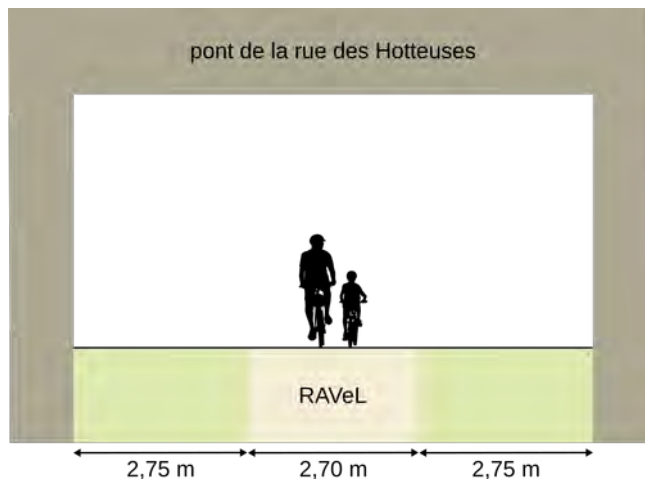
Coupe schématique du pont de la rue des Hotteuses
